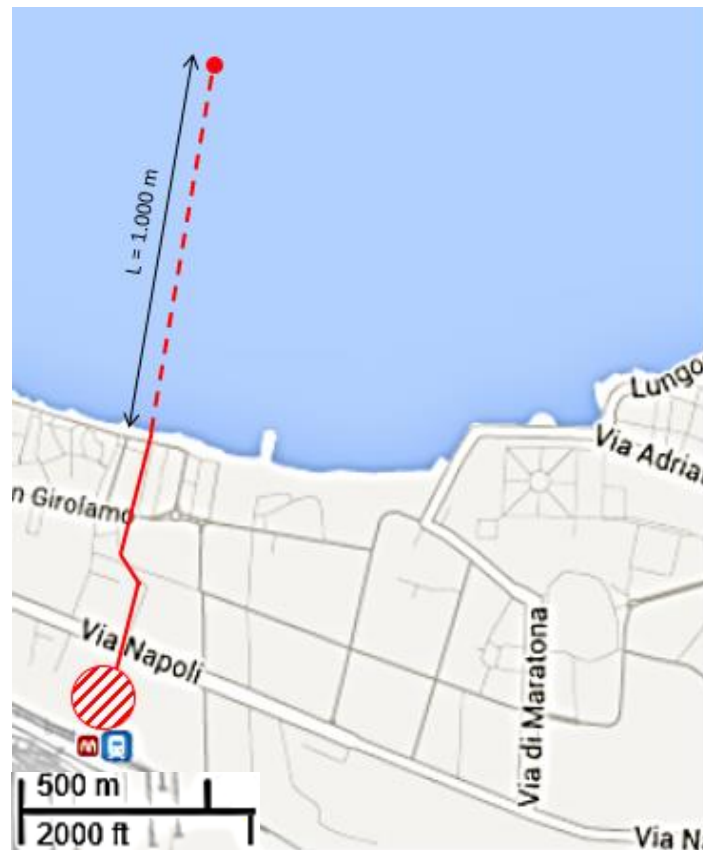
Rappresentazione planimetrica della condotta sottomarina di intake. Come visto in Figura 4.2 l'impianto per ragioni di spazio è stato collocato leggermente all'interno rispetto alla costa. La condotta di presa, rappresentata con un tratteggio, è collegata idraulicamente ad una vasca interrata posta in prossimità della costa la quale è alimentata per gravità mediante la condotta stessa. La profondità di questa vasca è studiata in modo da assicurare un pelo libero inferiore al livello del mare in modo da garantire l'adduzione di una certa portata di acqua per mezzo della condotta, anche nei periodi di bassa marea. Il collegamento idraulico tra la vasca interrata posta in prossimità della costa e l'impianto è dato da una condotta interrata, rappresentata in figura con una linea spezzata a tratto continuo.
